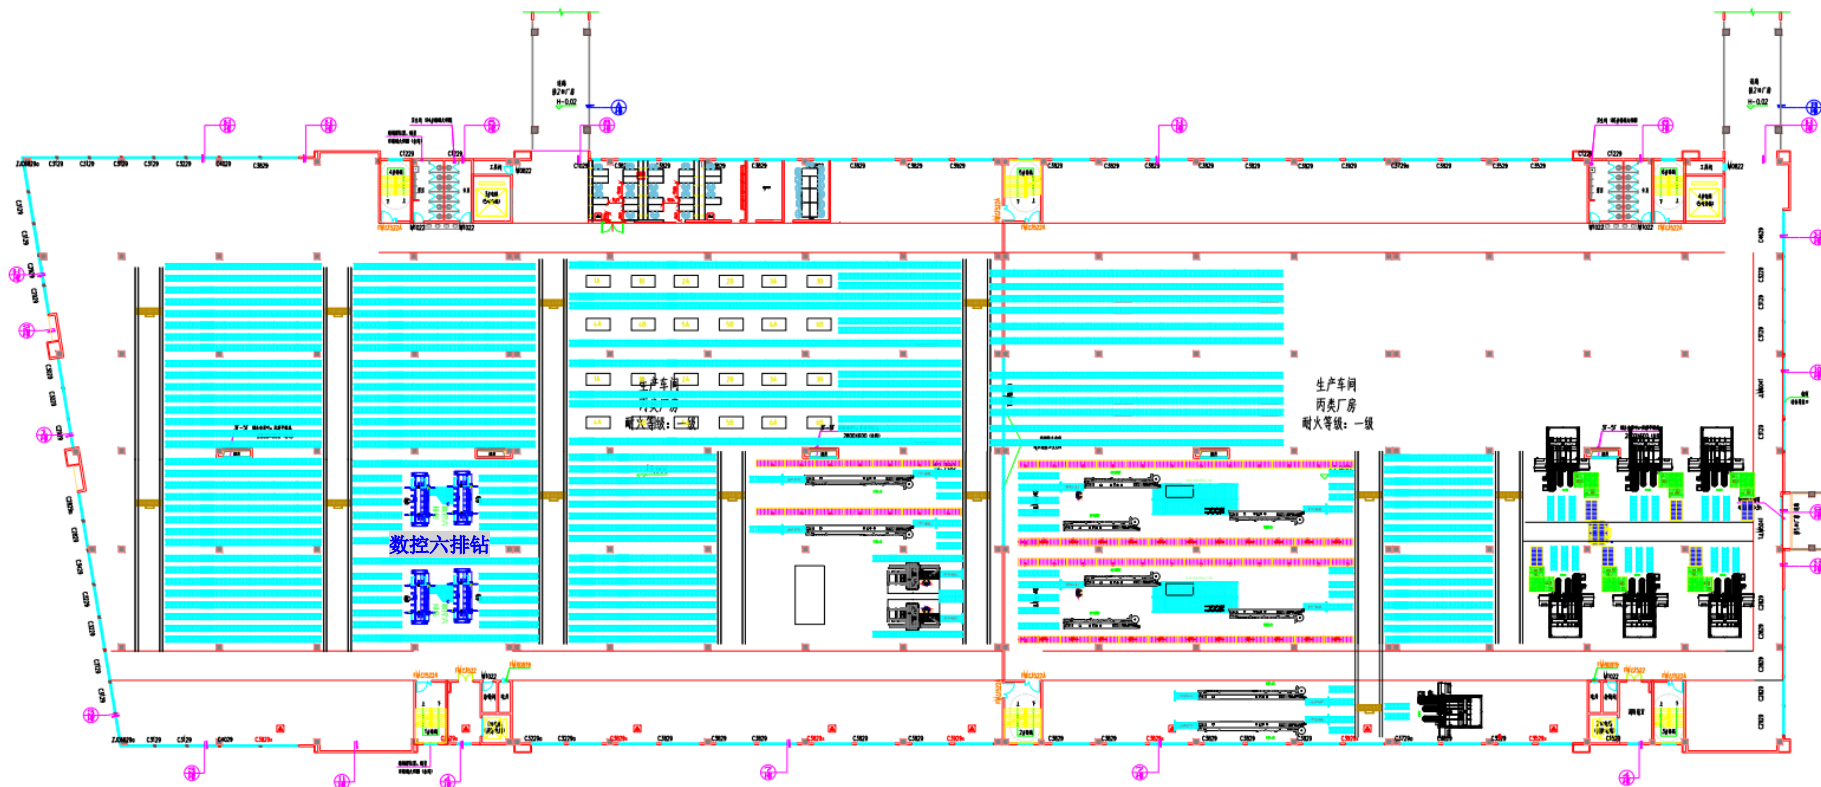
非标浴室柜生产车间（1#四层）平面布置图
